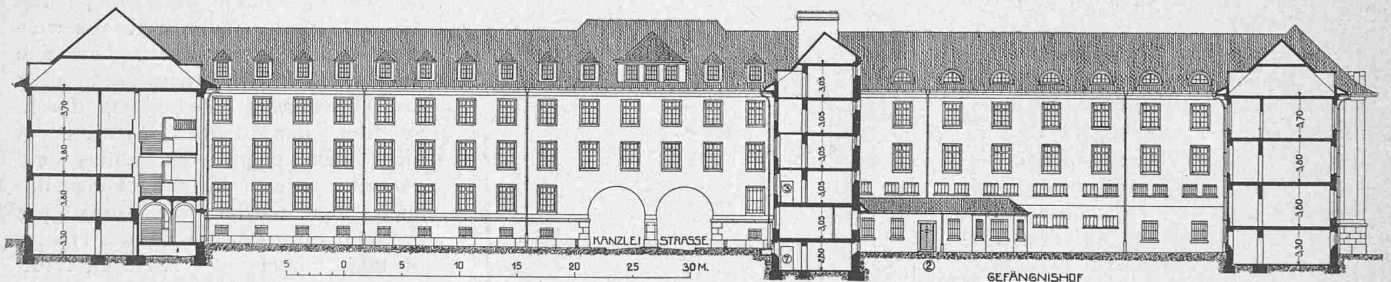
Schnitt durch Gericht (Treppenhaus), Zellenbau und Bezirksanwaltschafts-Gebäude mit den Hoffassaden. — 1:600.
